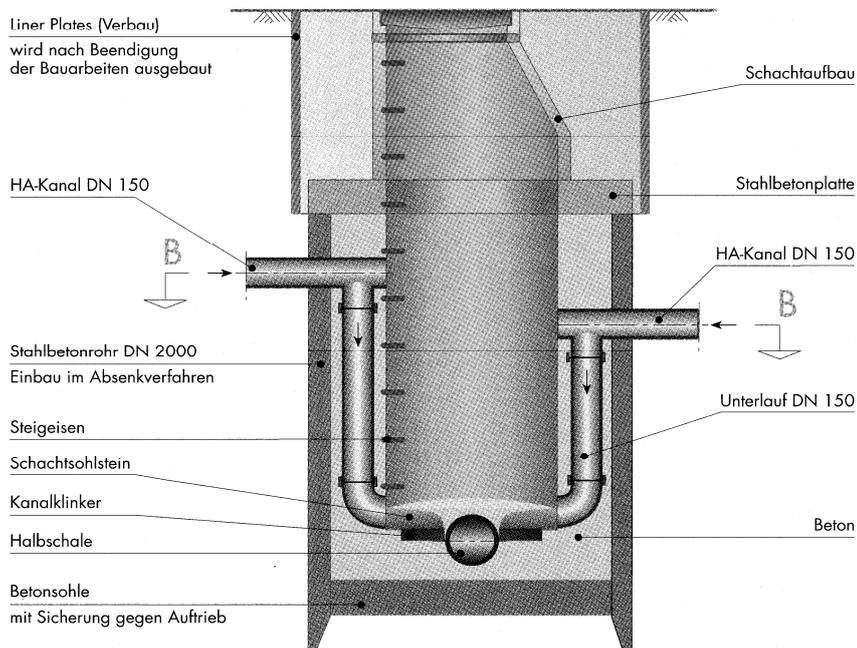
Schnitt eines Schachtes für sternförmig einzuleitende Hausanschlussleitungen [1]
